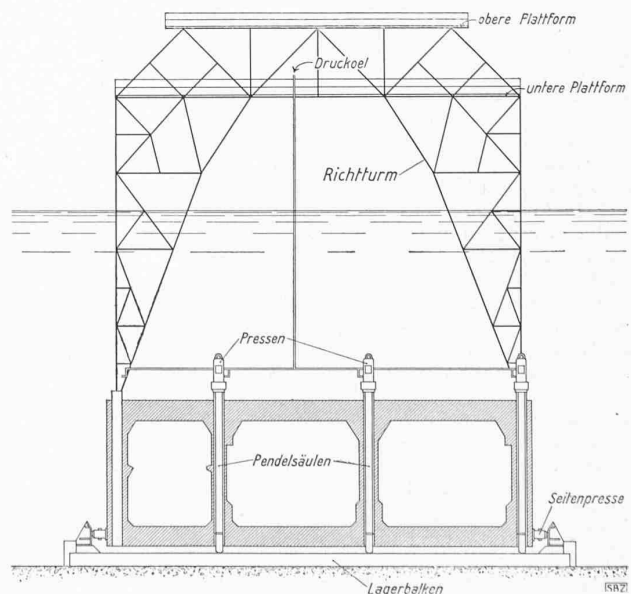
Schema der Auflagerung und Ausrichtung eines Tunnel- stücks (äusserste Pendelsäule links nicht gezeichnet)
